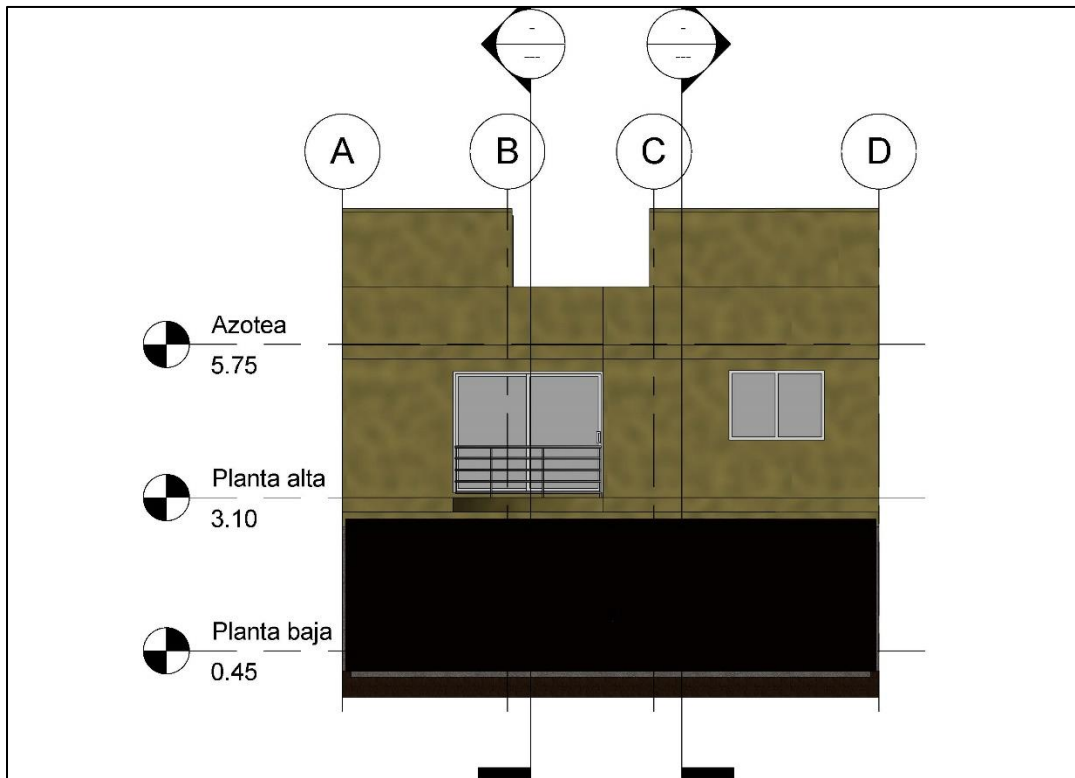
Plano de vivienda no sustentable: fachada Norte. Fuente: autoría propia
